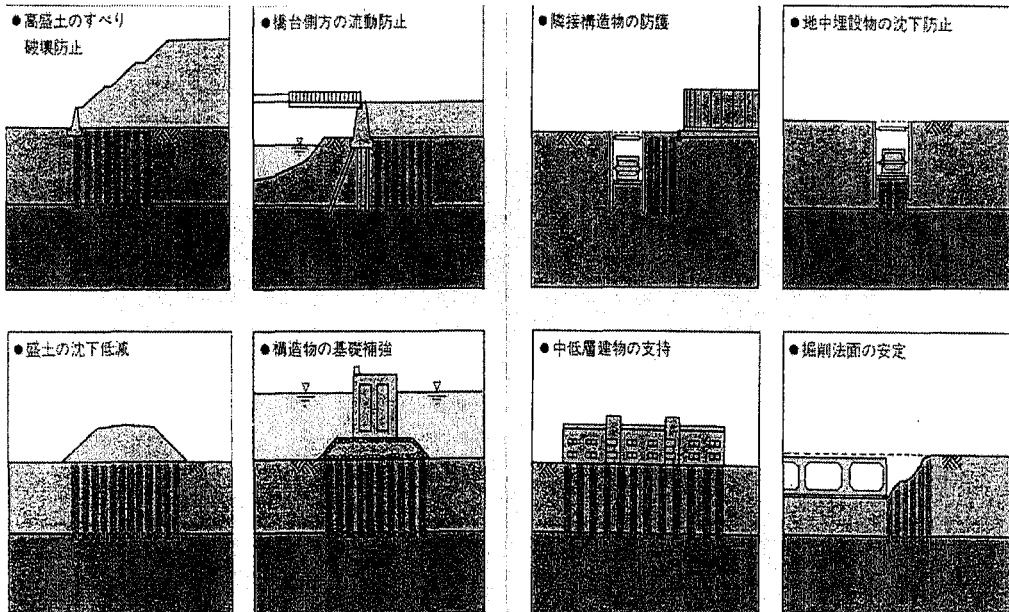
Deniz yapılarında Jet Grout yöntemi [13]
